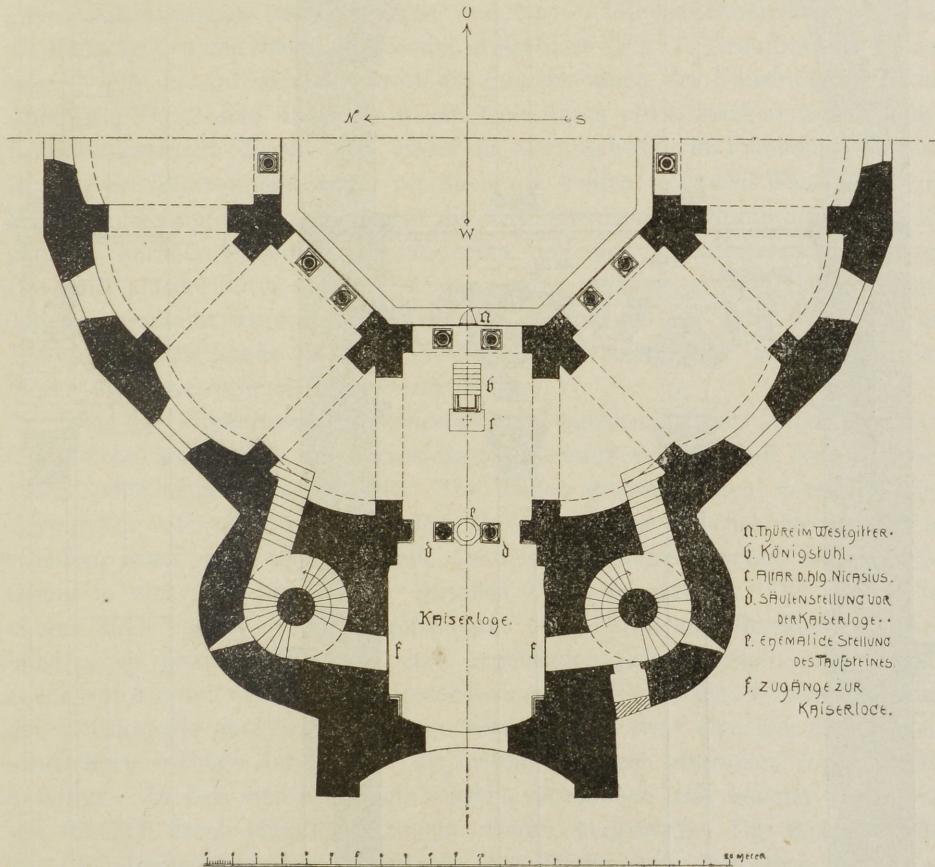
Aachen, Münster. Grundriss der Kaiserloge.
